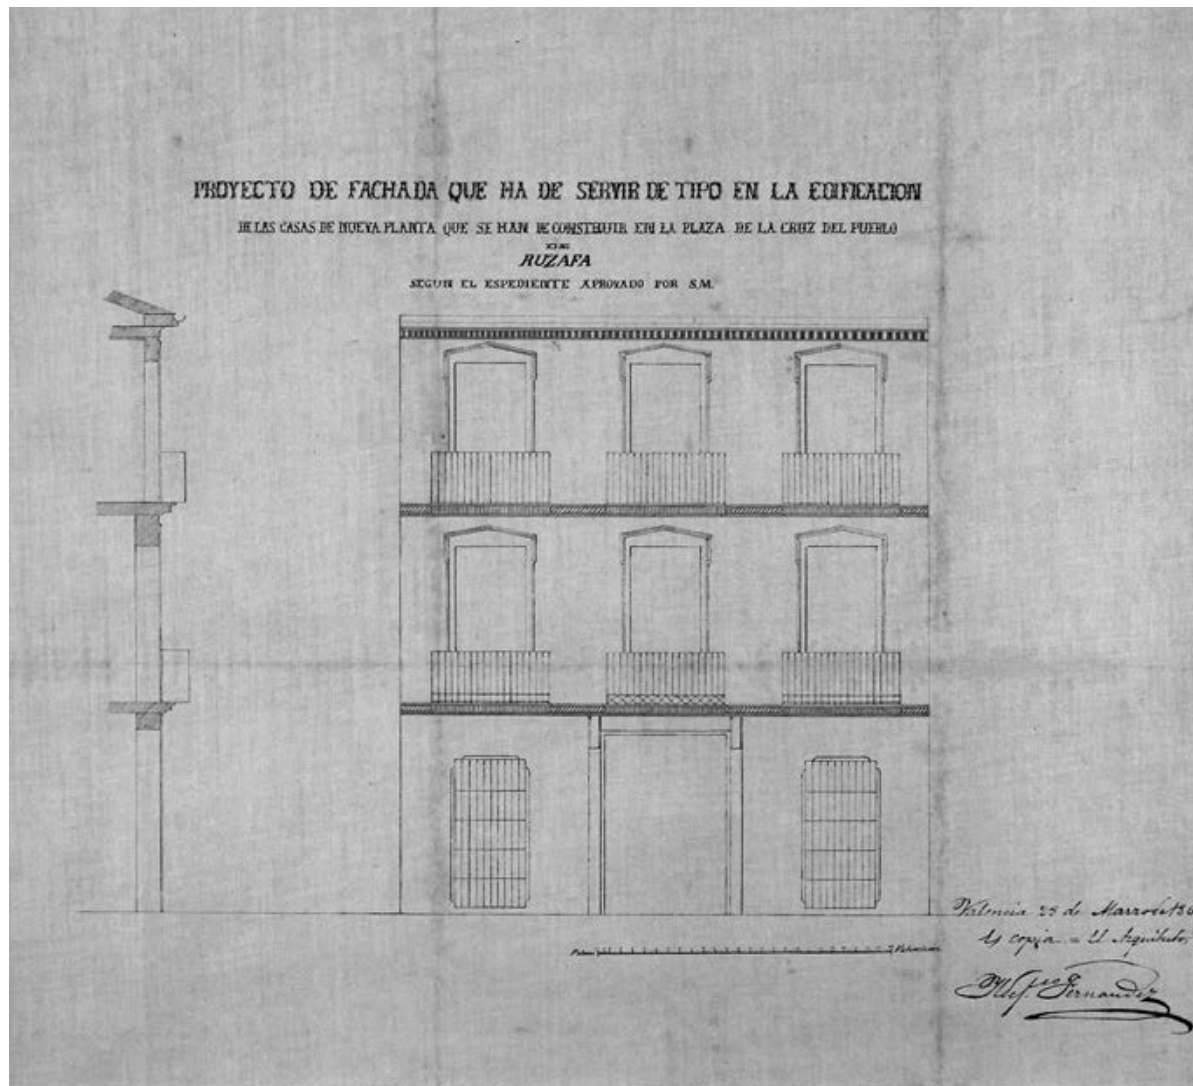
Proyecto de fachada de Ildefonso Fernández que ha de servir de tipo en la edificación de las casas de nueva planta que se han de construir en la plaza de la Cruz del pueblo de Ruzafa en 1866.
